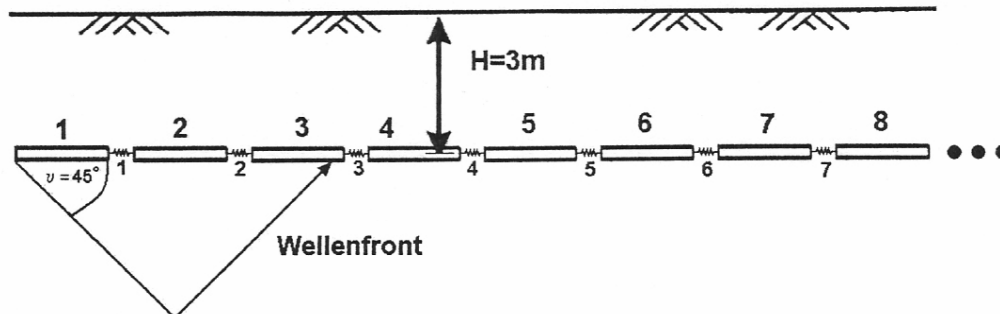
Beispiel 3: segmentierte Beton-Rohrleitung.
